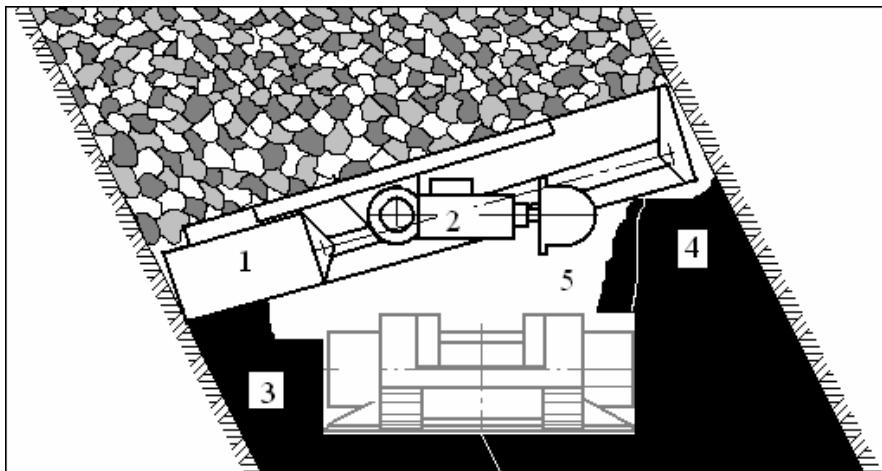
Положение секции перекрытия после подработки опорного целика у почвы пласта: 1 — секция перекрытия; 2 — стреловидный исполнительный орган секции; 3 — целик у почвы пласта; 4 — целик у кровли пласта; 5 — опережающая канава монтажного слоя
